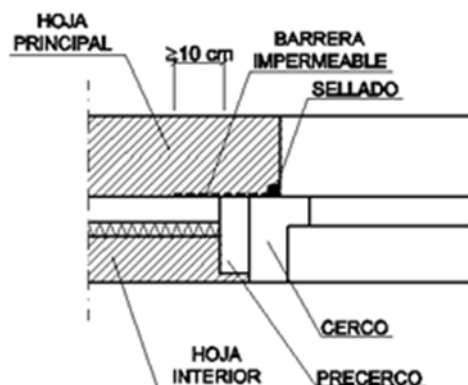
Ejemplo de encuentro de la fachada con la carpintería
